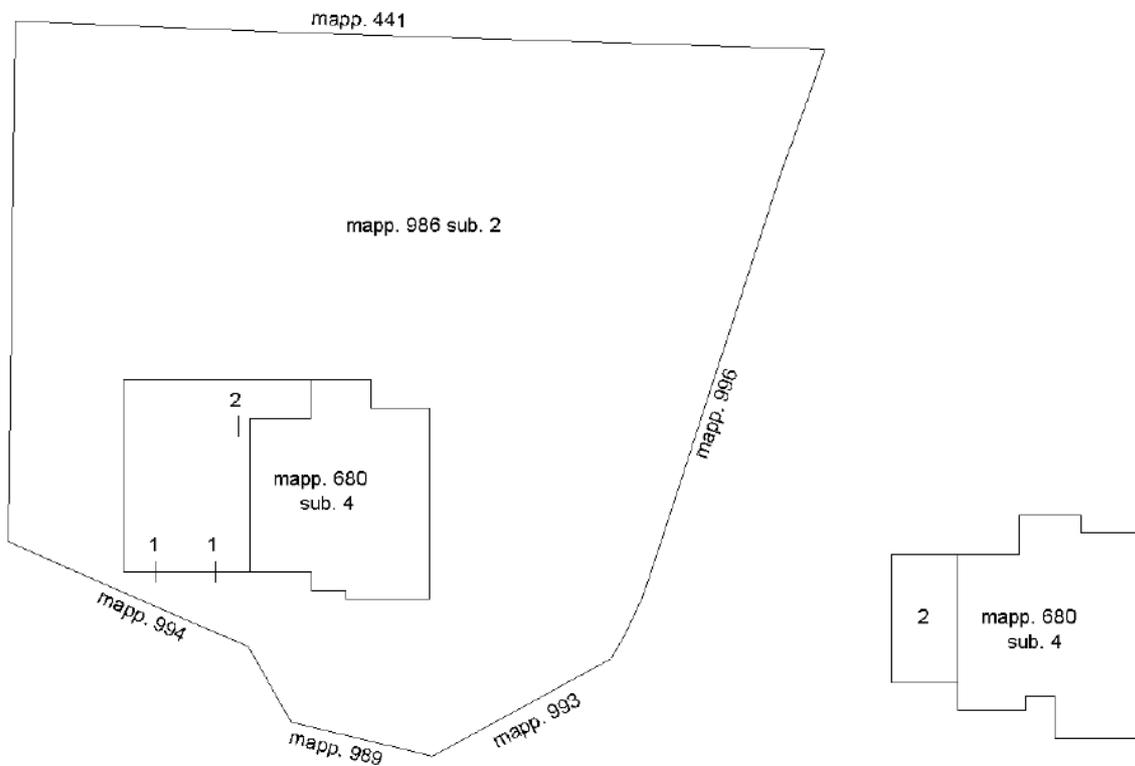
Estratto elaborato planimetrico (p.t. a sx e p.p. a dx).
